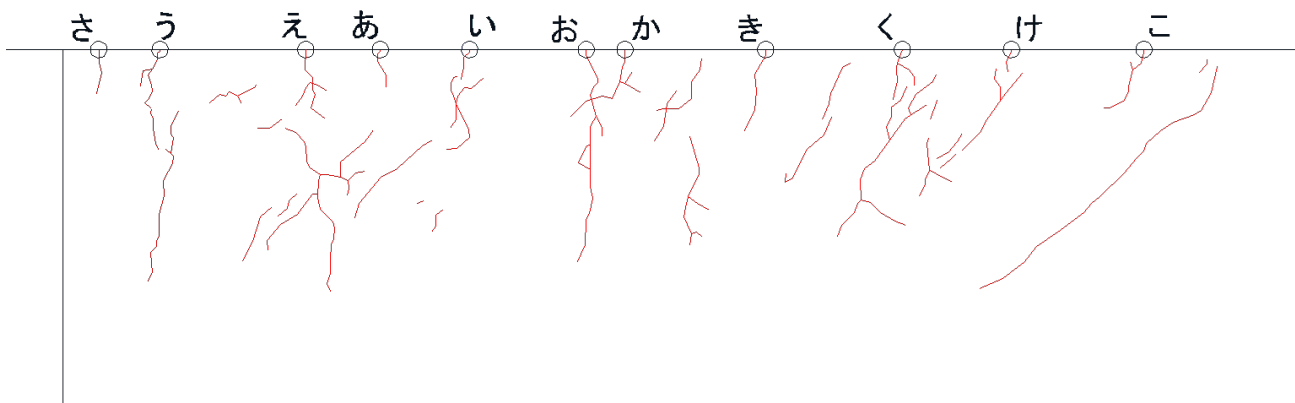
基礎梁ひび割れ幅測定位置(試験体 D-1 負荷荷)
